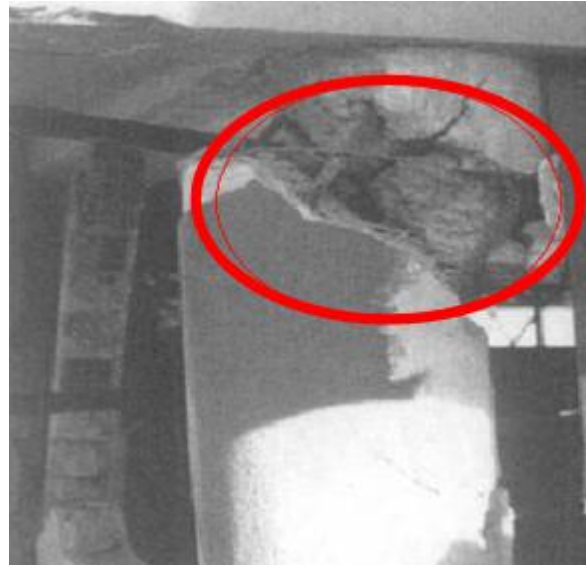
Rupture par cisaillement d'un poteau béton armé lors du séisme de Boumerdes 2003. [4]
